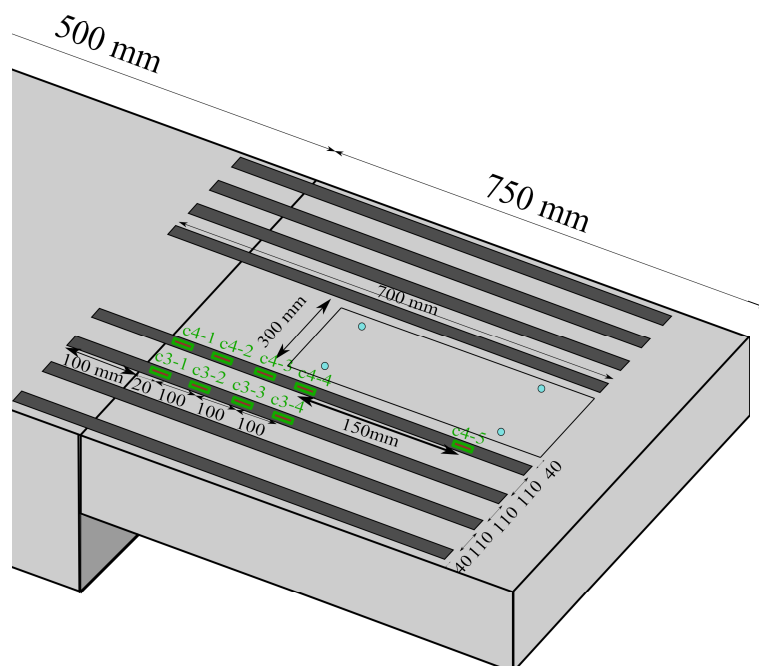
Position des jauges de déformation sur les plats en PRF de la dalle 3
